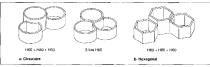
• Assemblages de jardinières prefabriquées en béton armé.
